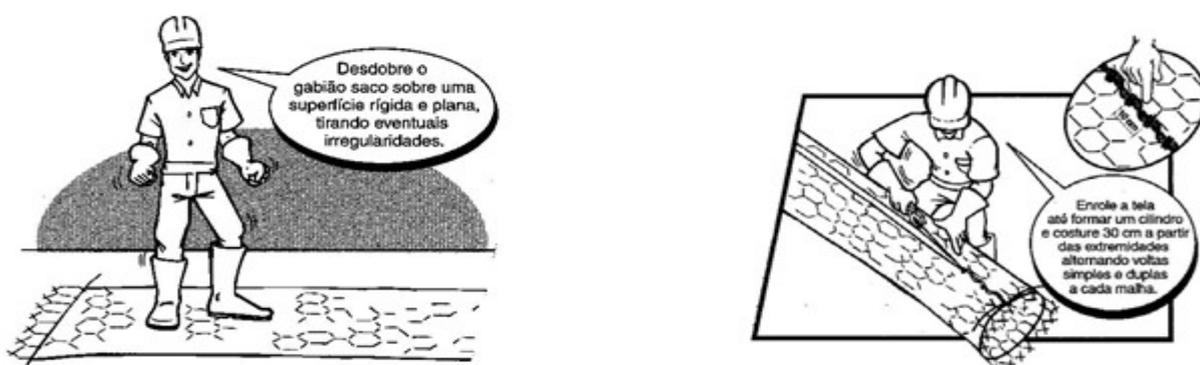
Preparação de um gabião saco e detalhe de amarração
